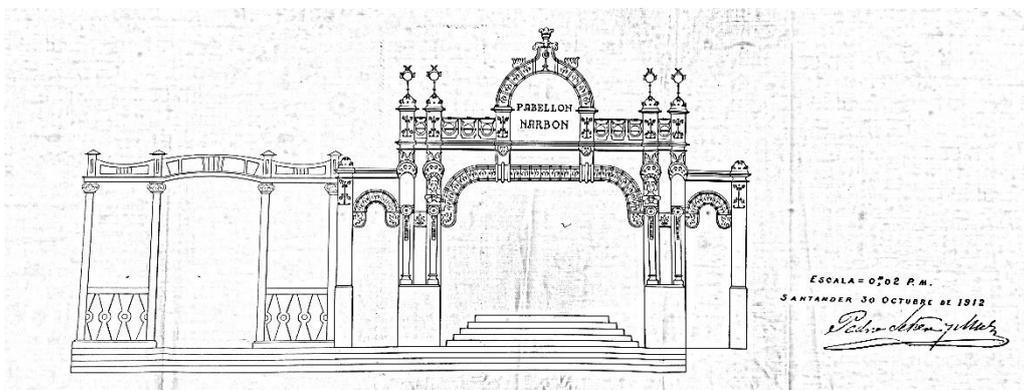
Plano de la fachada principal del Pabellón Narbón editado por el autor / Archivo Municipal de Santander.
